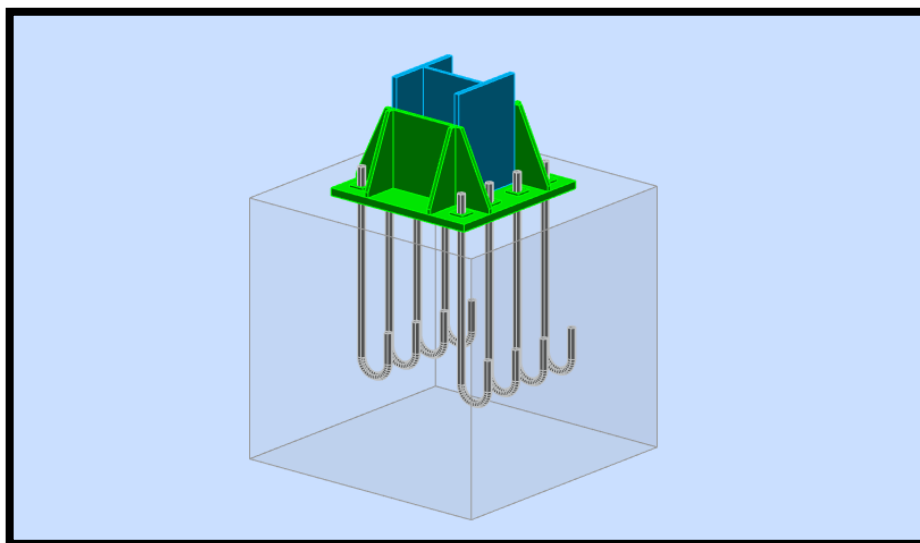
Représentation de l'assemblage pied poteau encastré.
